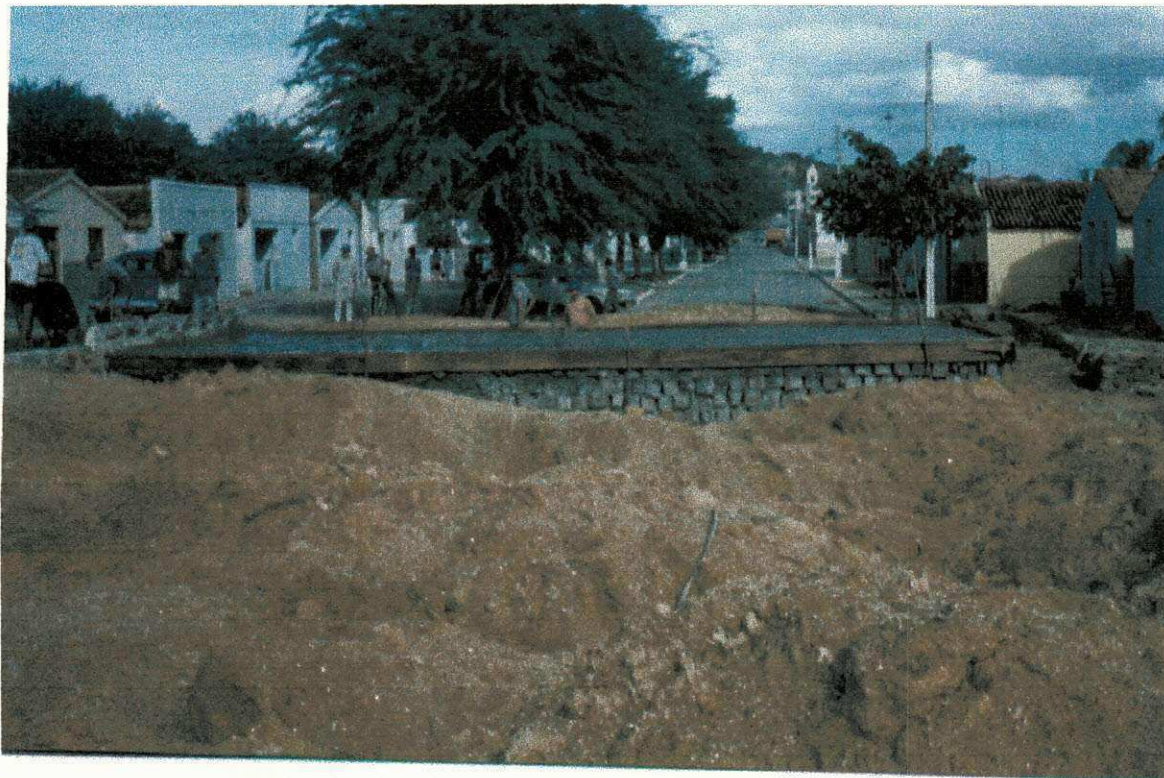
CONCRETAGEM DA PONTE SEGUIDO DE UM ATERRO
